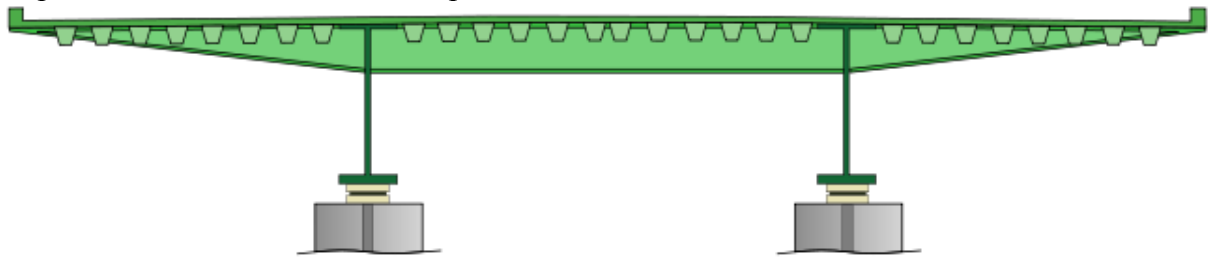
Poutres sous chaussée en métal avec dalle orthotrope
